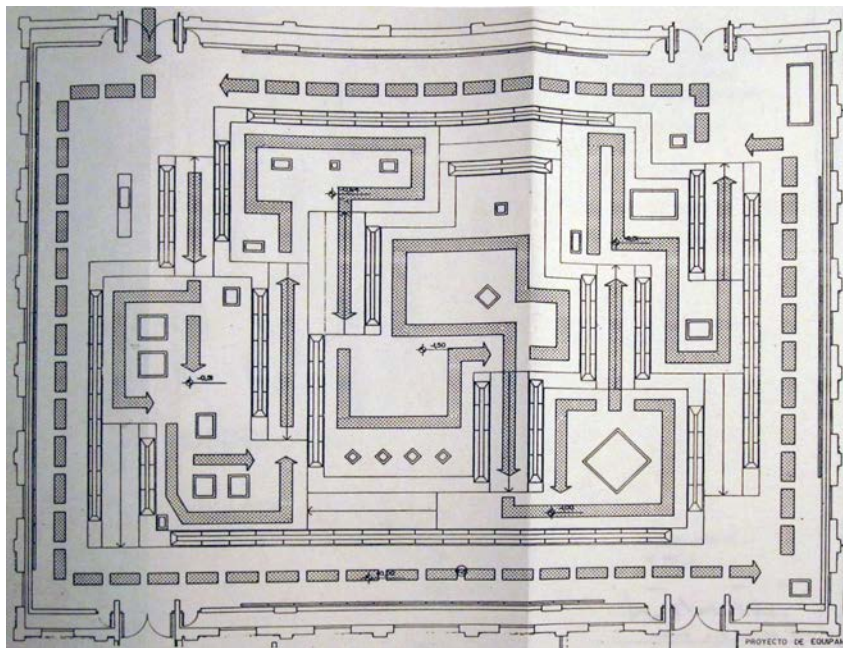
Planta de la sala principal de exposiciones (según J.M. Pérez Latorre)
